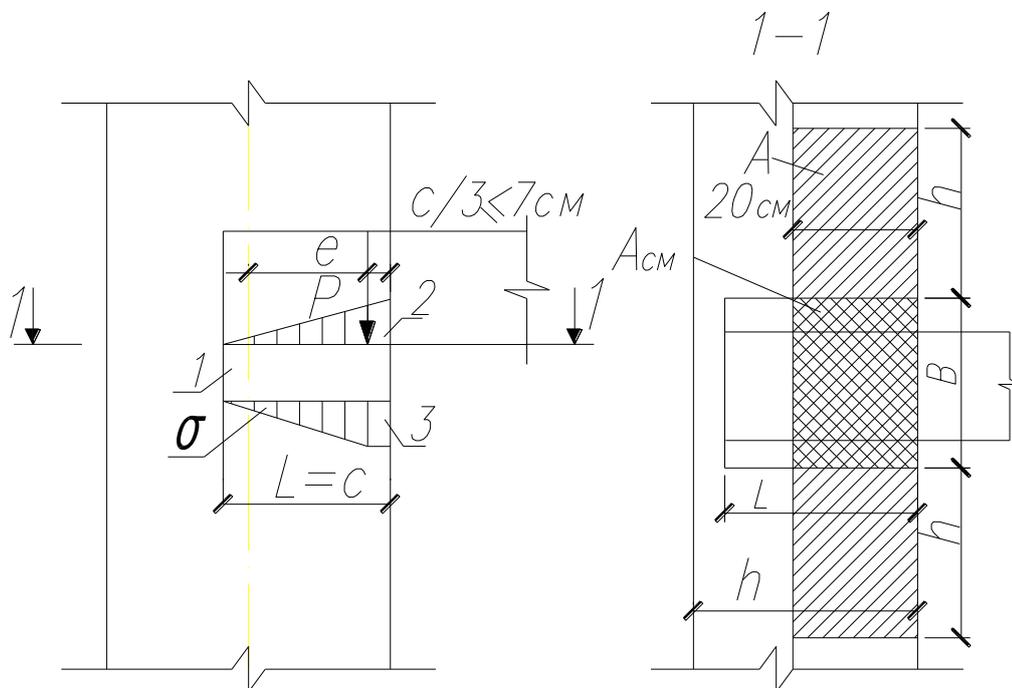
Схемы к расчету опорного узла с распределительной плитой
